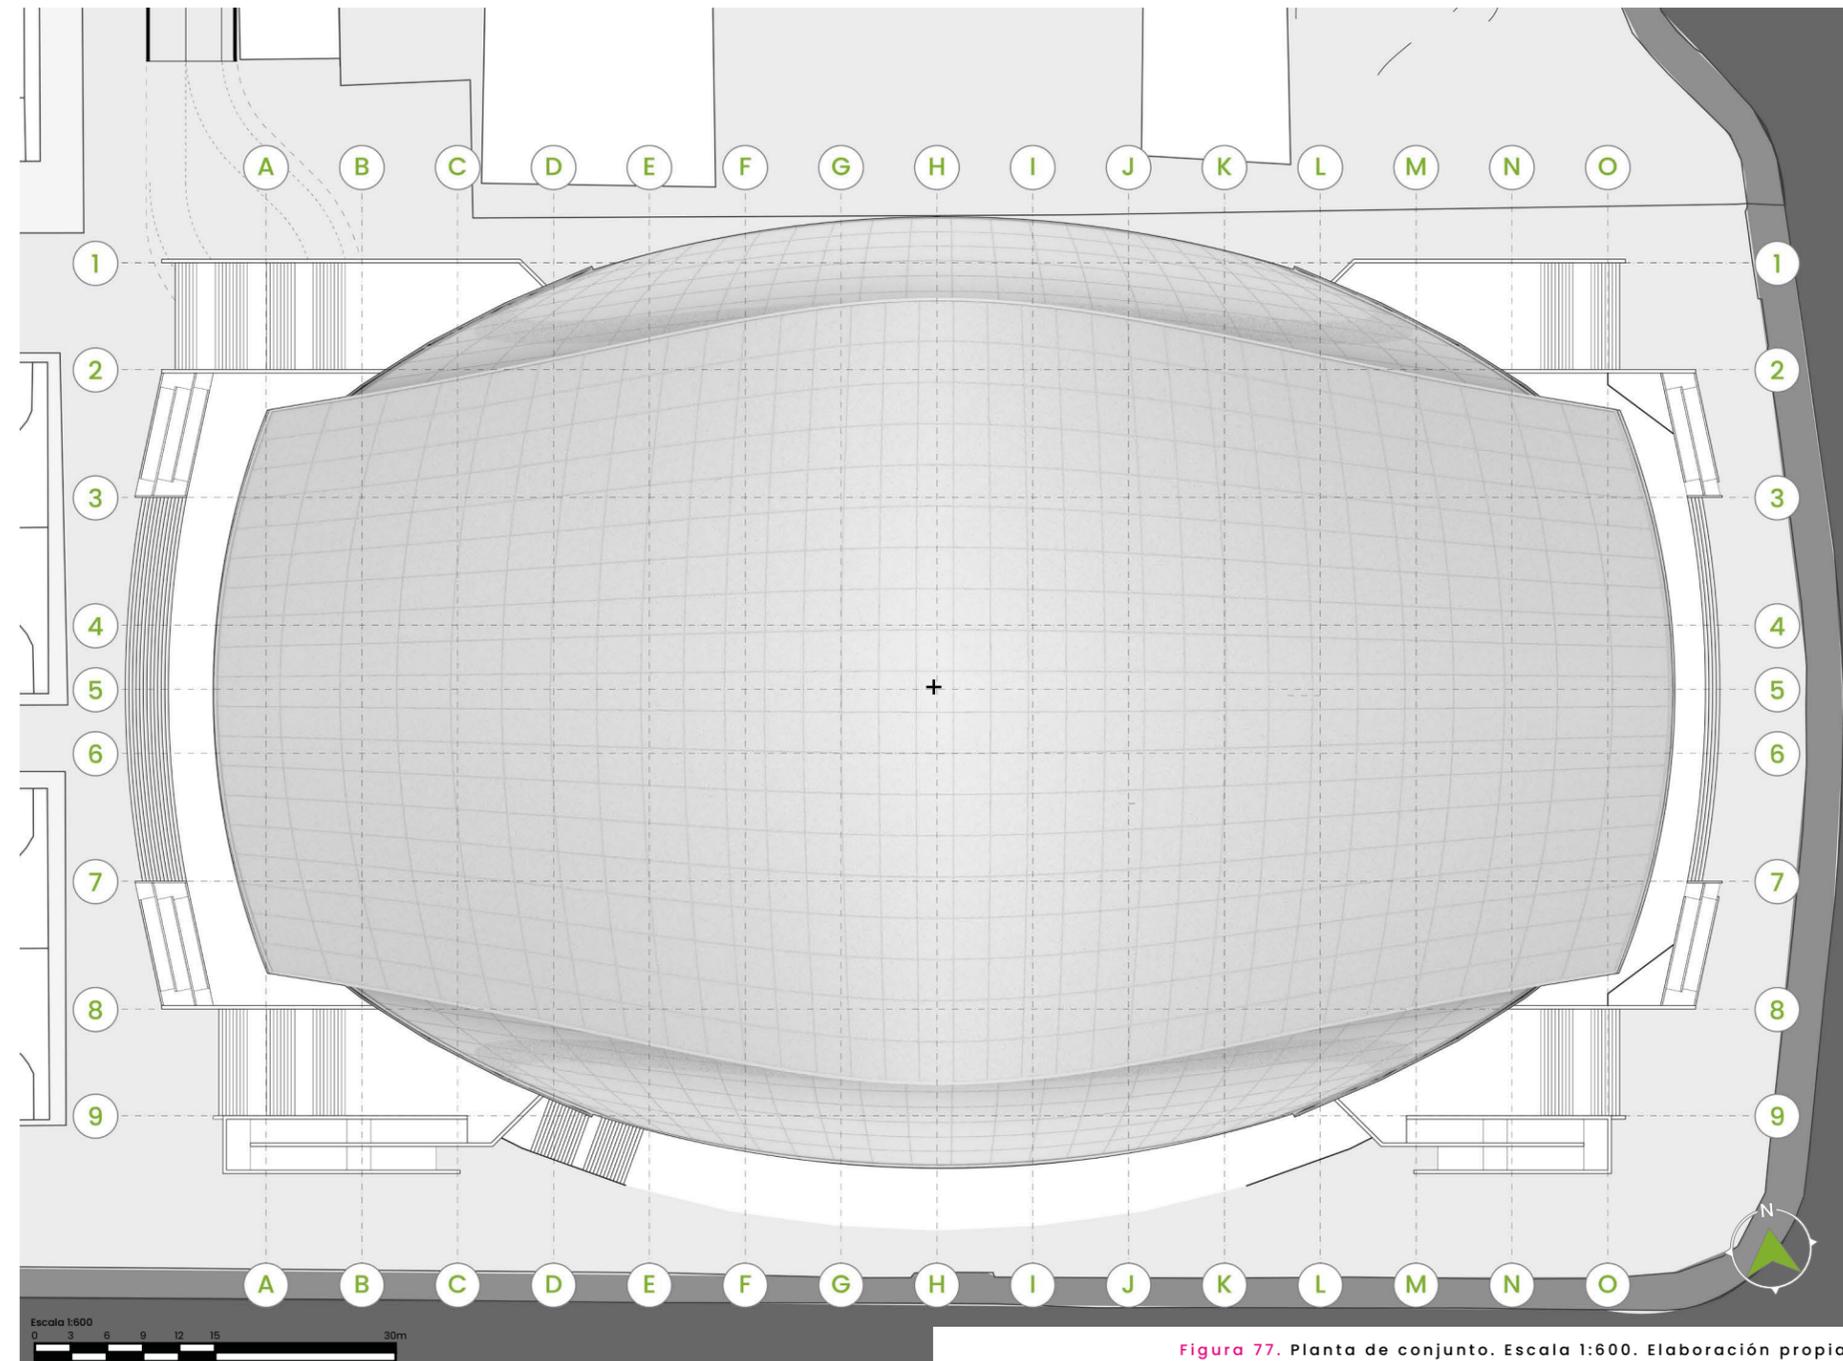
Planta de conjunto. Escala 1:600. Elaboración propia.
